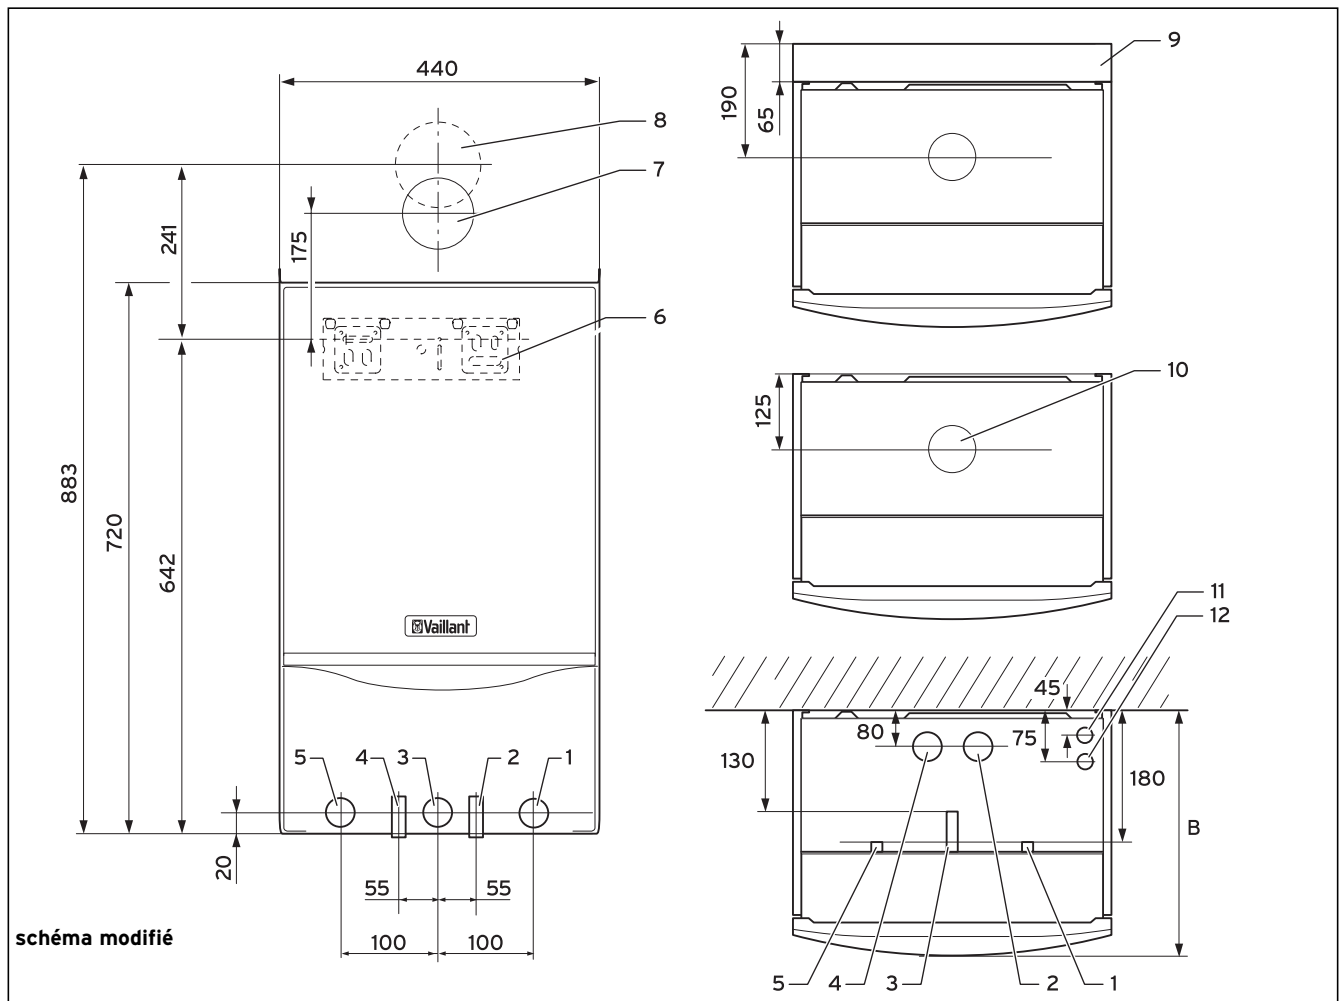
Dimensions de raccordement en mm (appareil VC)
